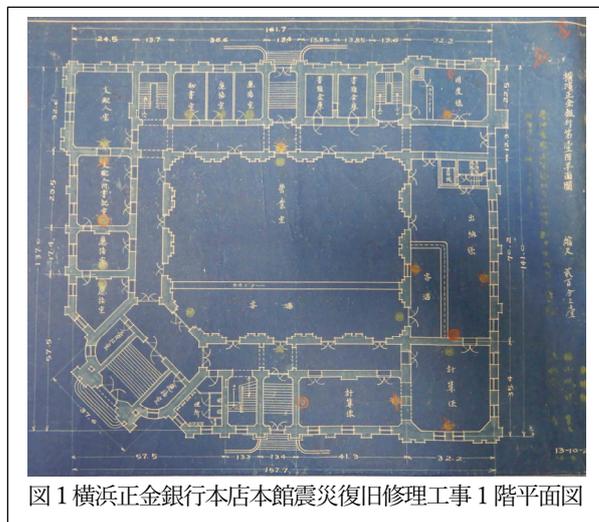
横浜正金銀行本店本館震災復旧修理工事1階平面図
